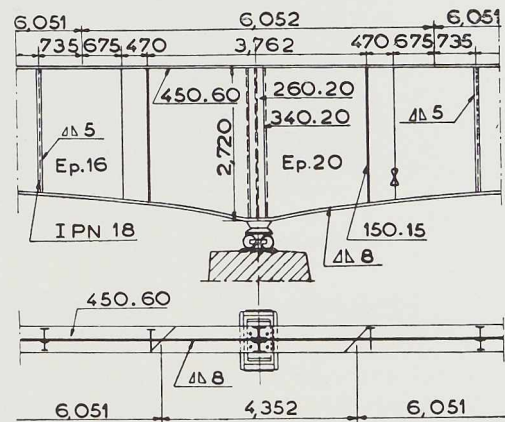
Détail de la maîtresse-poutre au-dessus de l'appui.
